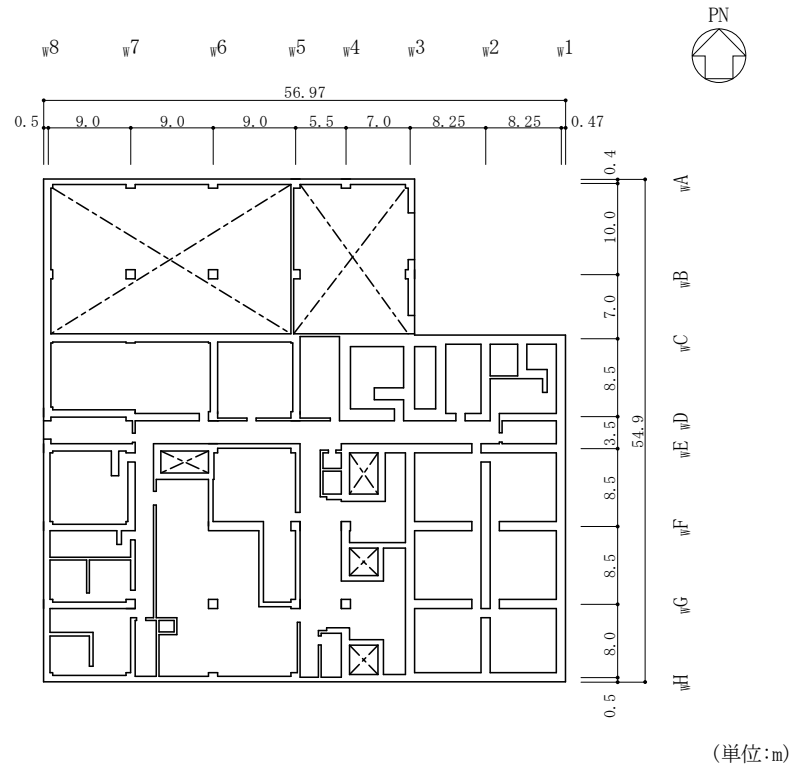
(6) 廃棄物処理建物の概略平面図 (EL 26.7m)
